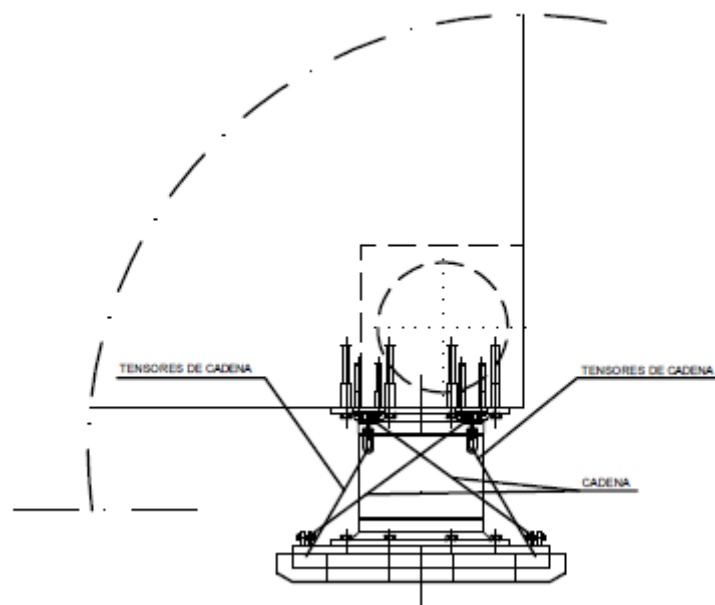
Vista en planta de la defensa doble SC-1000 H.
